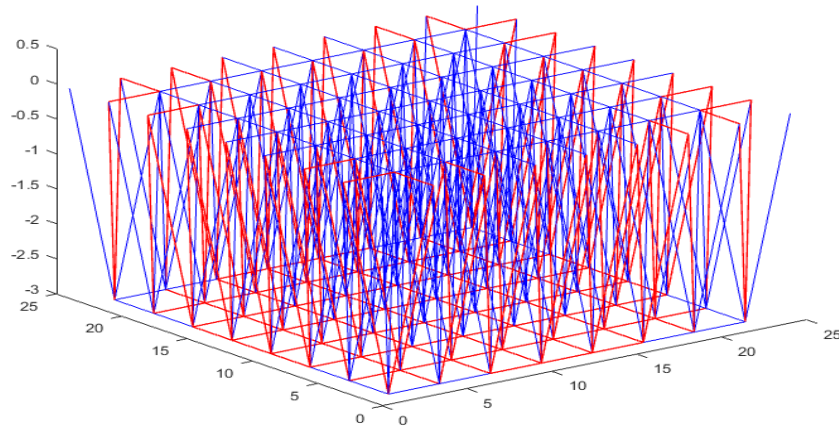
Стержни, вышедшие из работы на втором шаге догрузки первого расчета
